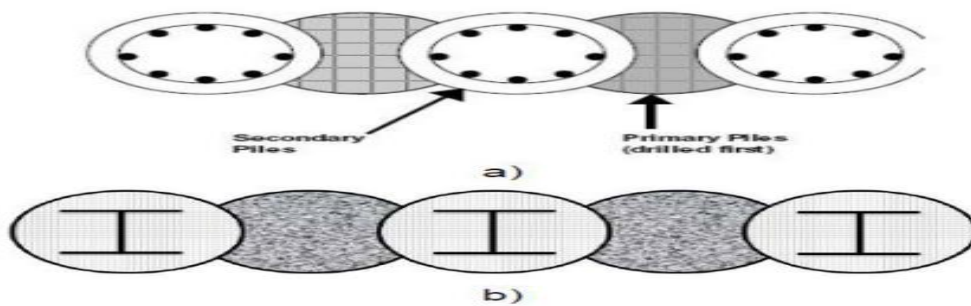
Vue en plan. a- une armure conventionnelle. b- le profil en acier. Lindquist et Jameson (2011).
